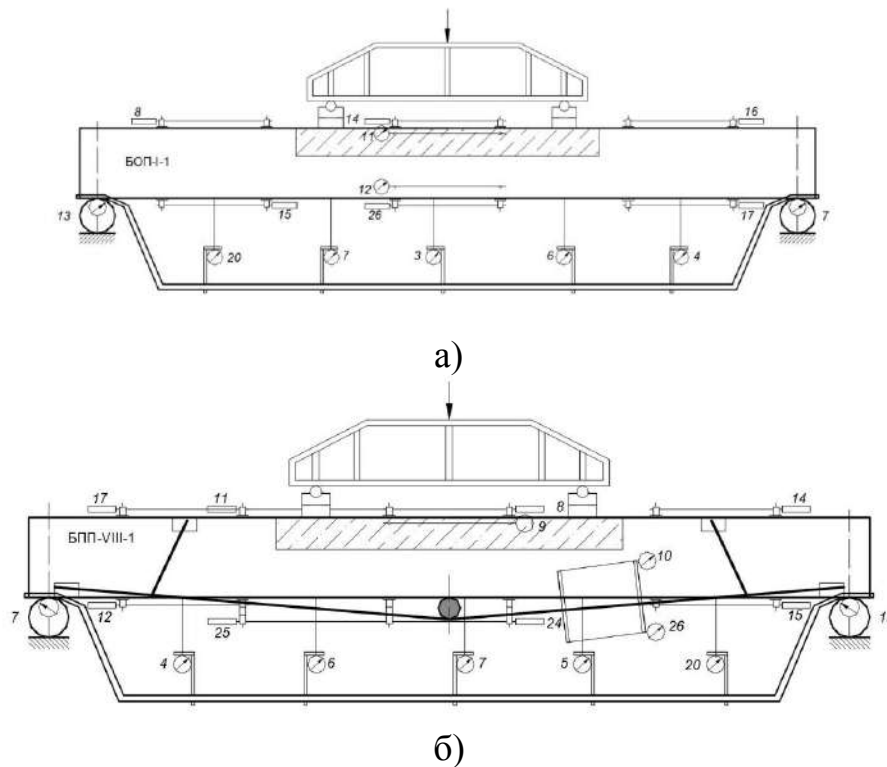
Схема випробування серії балок: а - залізобетонної балки БОП-I-1; б - залізобетонної балки БПП-VIII-1
